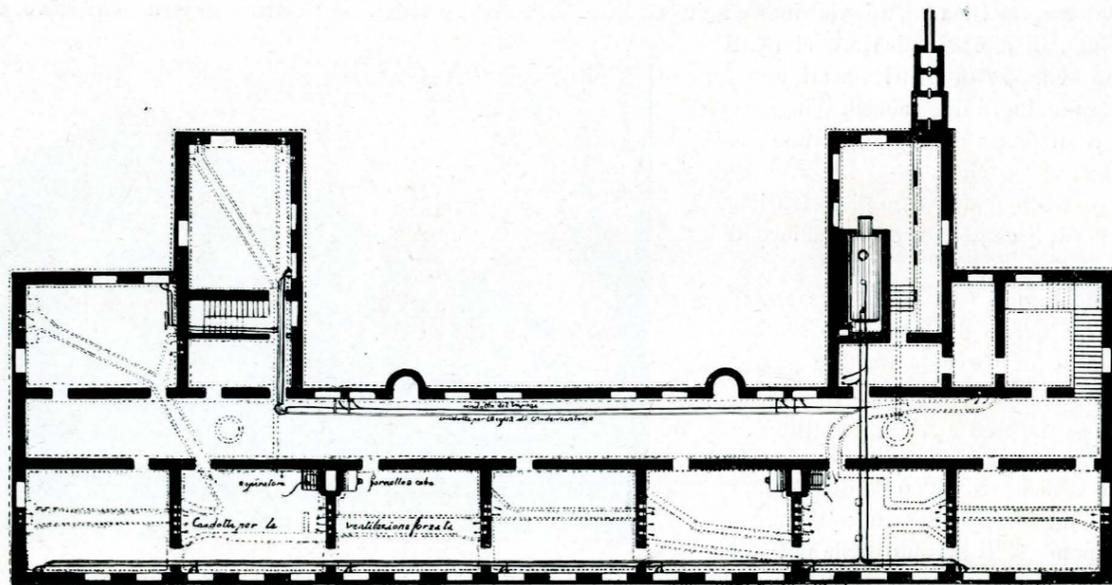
Edificio Scuole « Al Piacentino ». Pianta della fondazione. Particolari ventilazione e riscaldamento (Scala 1 : 400).
